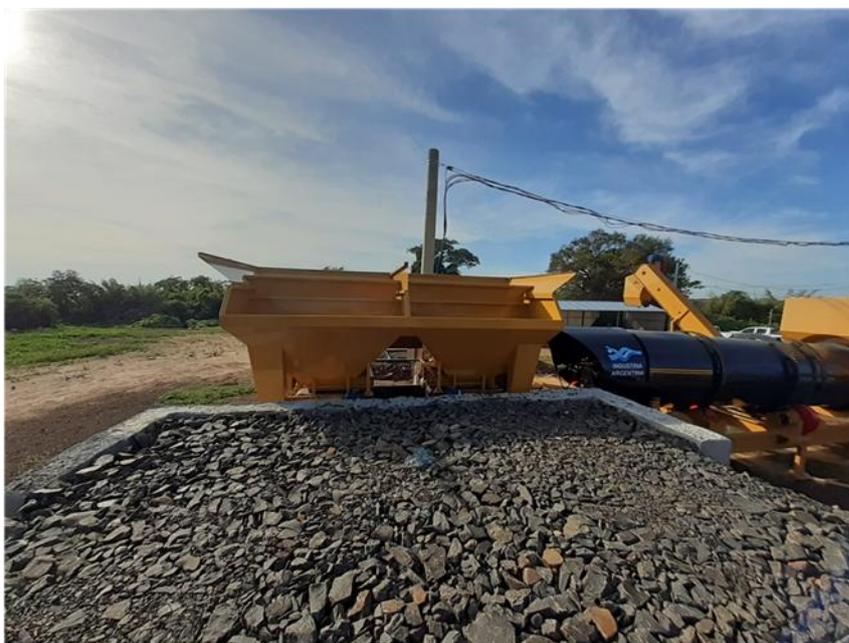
Foto del predio 12/06/2020. Posición 1 vista hacia el Este.
